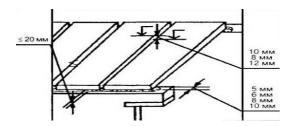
Схема допускаемых отклонений при монтаже плит перекрытия
